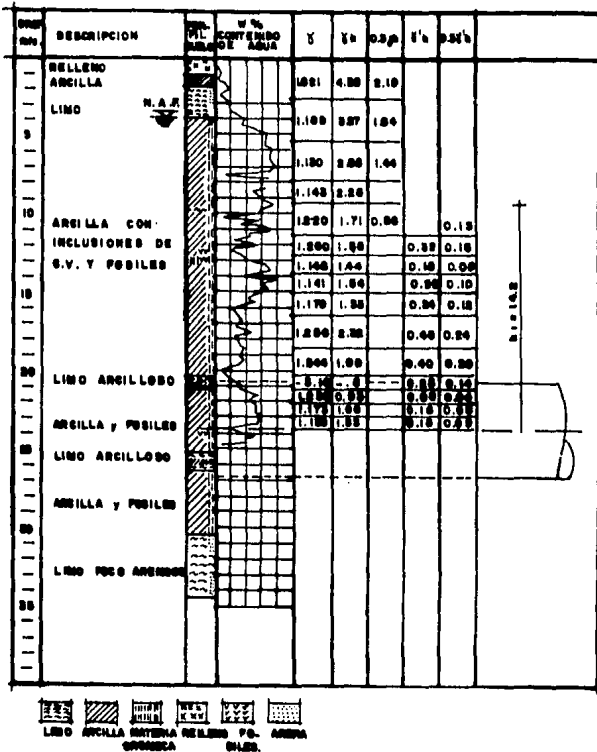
SONDEO O+ 936 DEL DRENAJE PROFUNDO.
